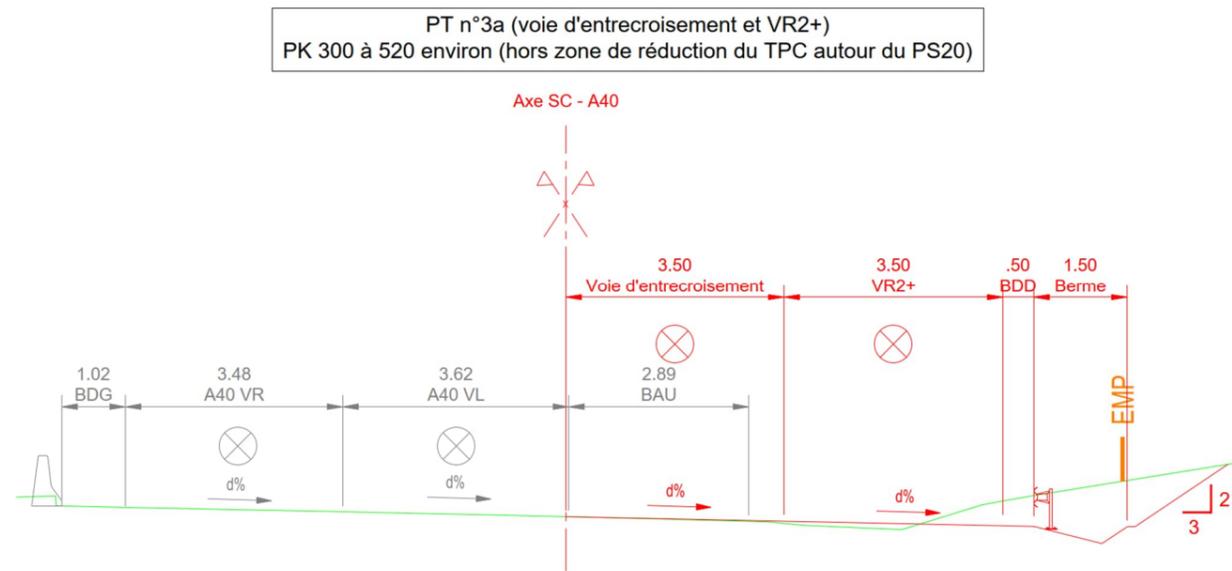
Profil en travers type du début de tracé de VR2+ - PT A
